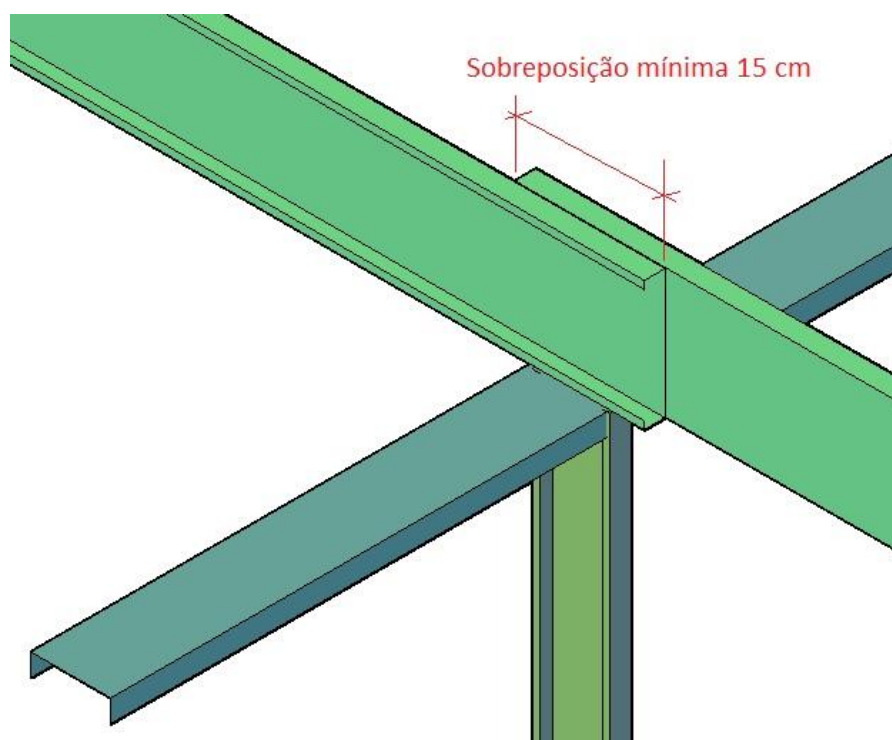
Viga contínua apoiada em parede estrutural
